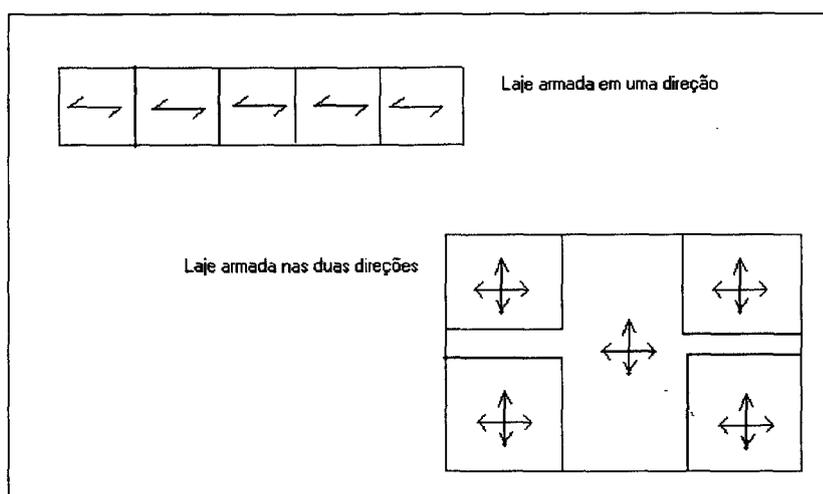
Esboço de lajes armadas em uma e duas direções.
